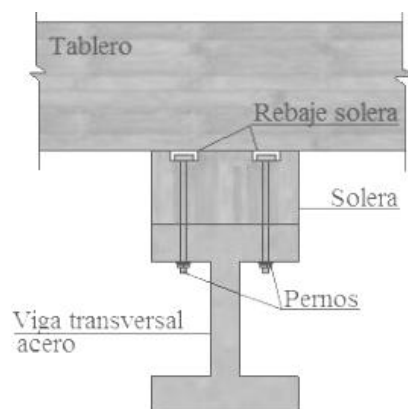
Detalle anclaje solera-viga transversal de acero [23]
